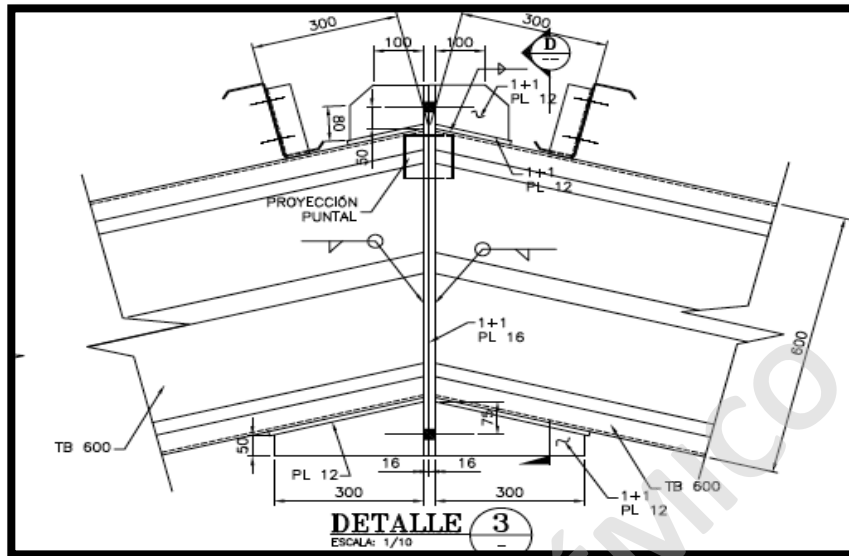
Detalle de Cumbre de Proyecto Mostazal ODR Ingeniería y Montajes
